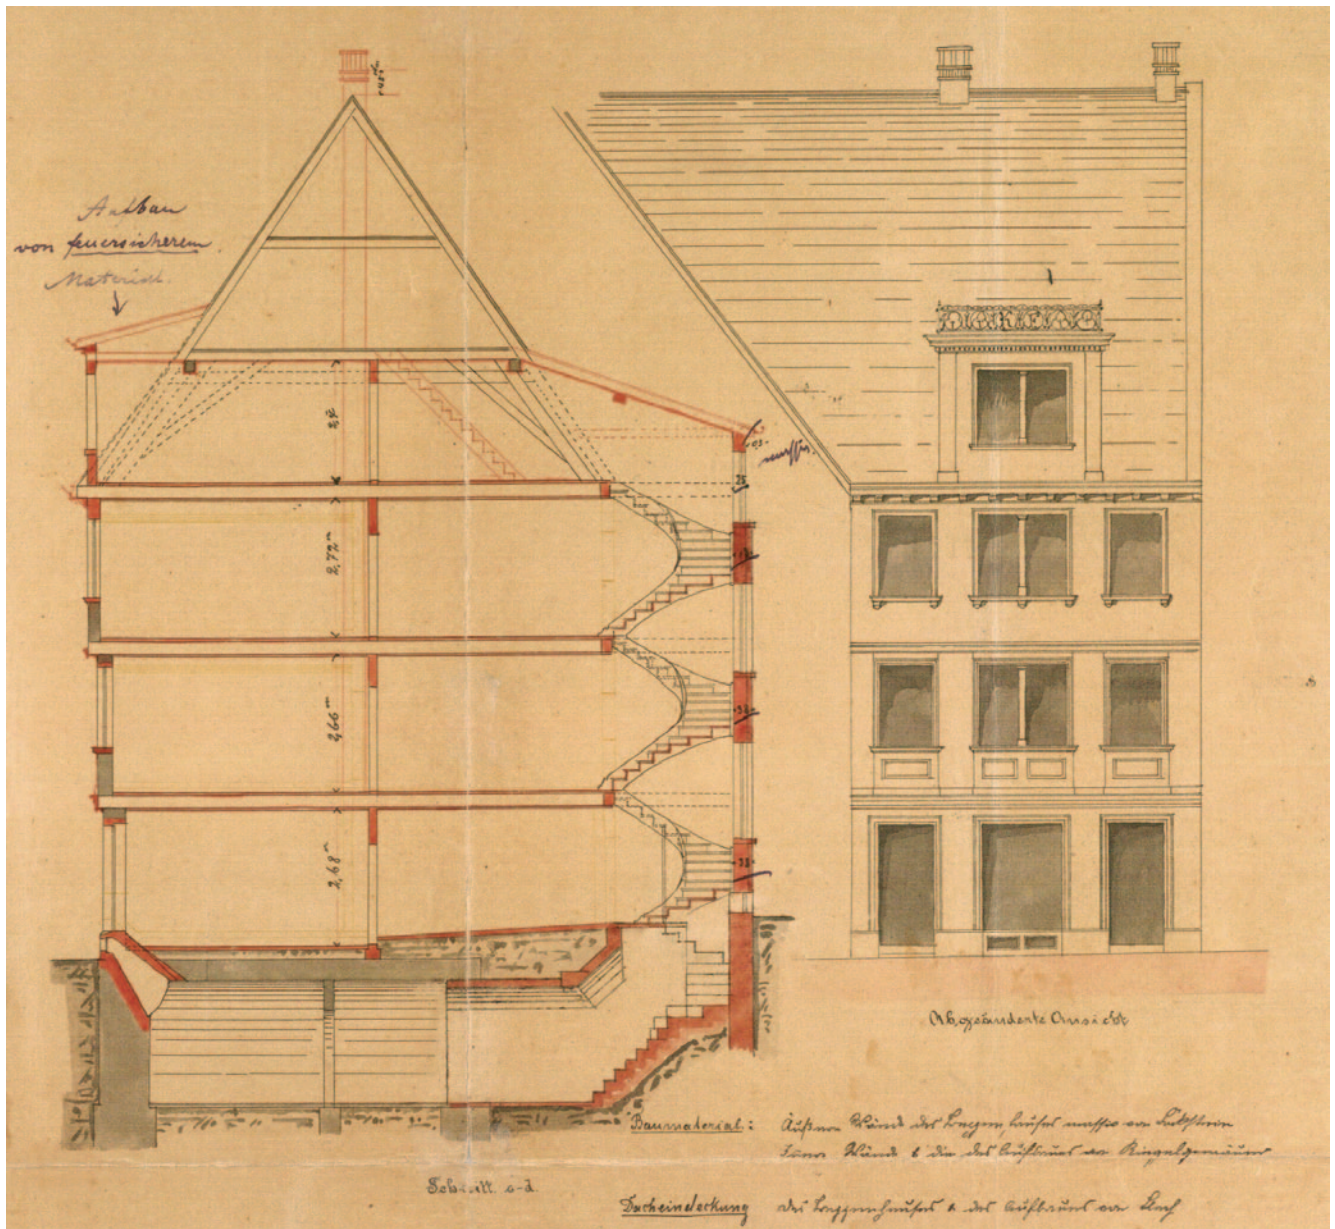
Gebäude Lange Straße 32 (A 302), Querschnitt des alten Hauses, Baugesuch 1875. Darstellung des liegenden Dachstuhl. Die baulichen Veränderungen wurden nicht ausgeführt.
